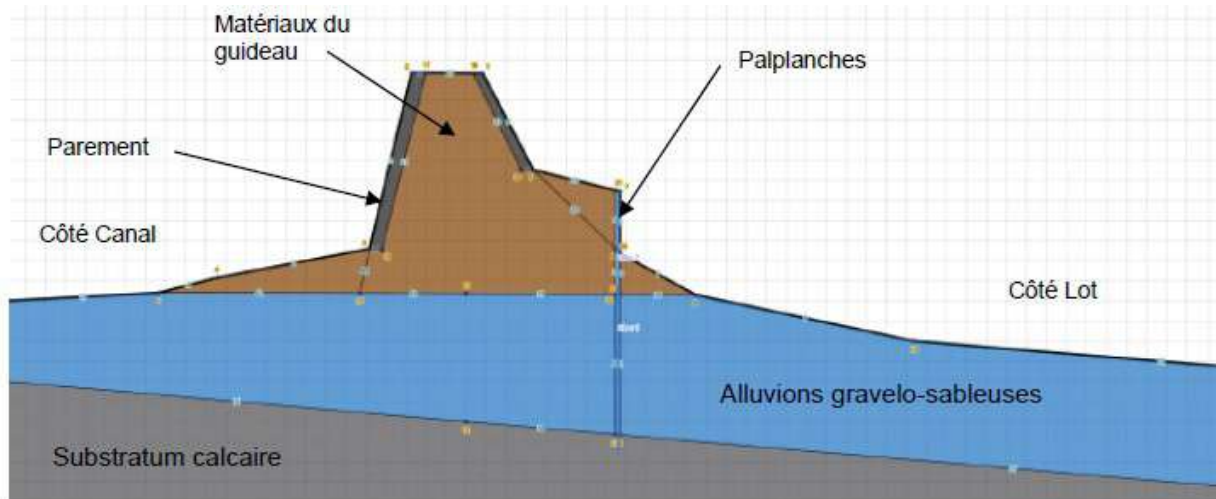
Coupe de calcul du site état actuel (Fondasol).
